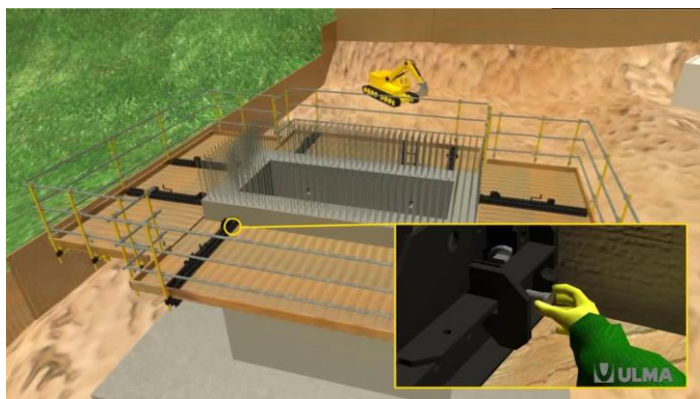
s. Detalle de cierre con pasador de las consolas.
